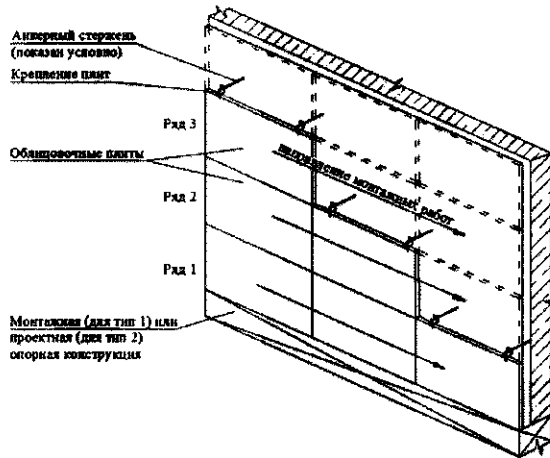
Схема крепления плит облицовочного слоя (тип 1 и тип 2)
